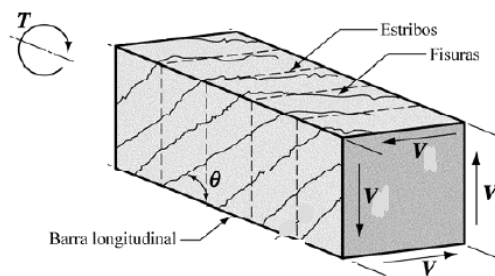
Fisuras por corte en una viga simplemente apoyada.
